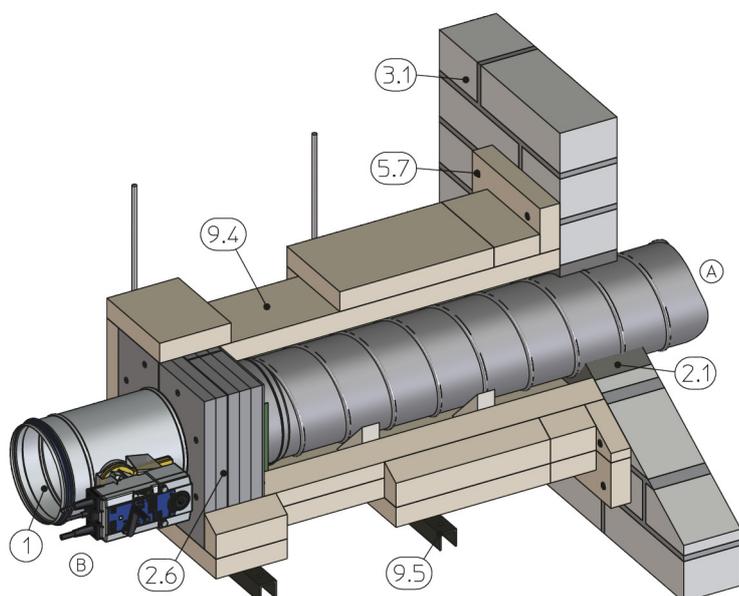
Montage à sec sans mortier dans un mur plein, avec kit de montage WA / WA2
